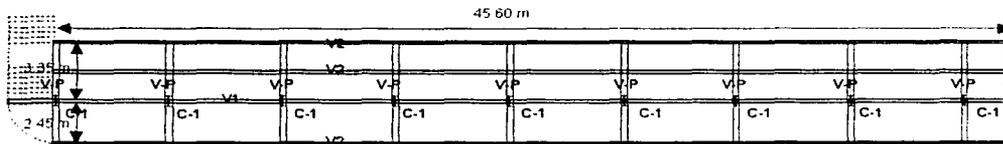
Distribución de Columnas y Vigas Metálicas
